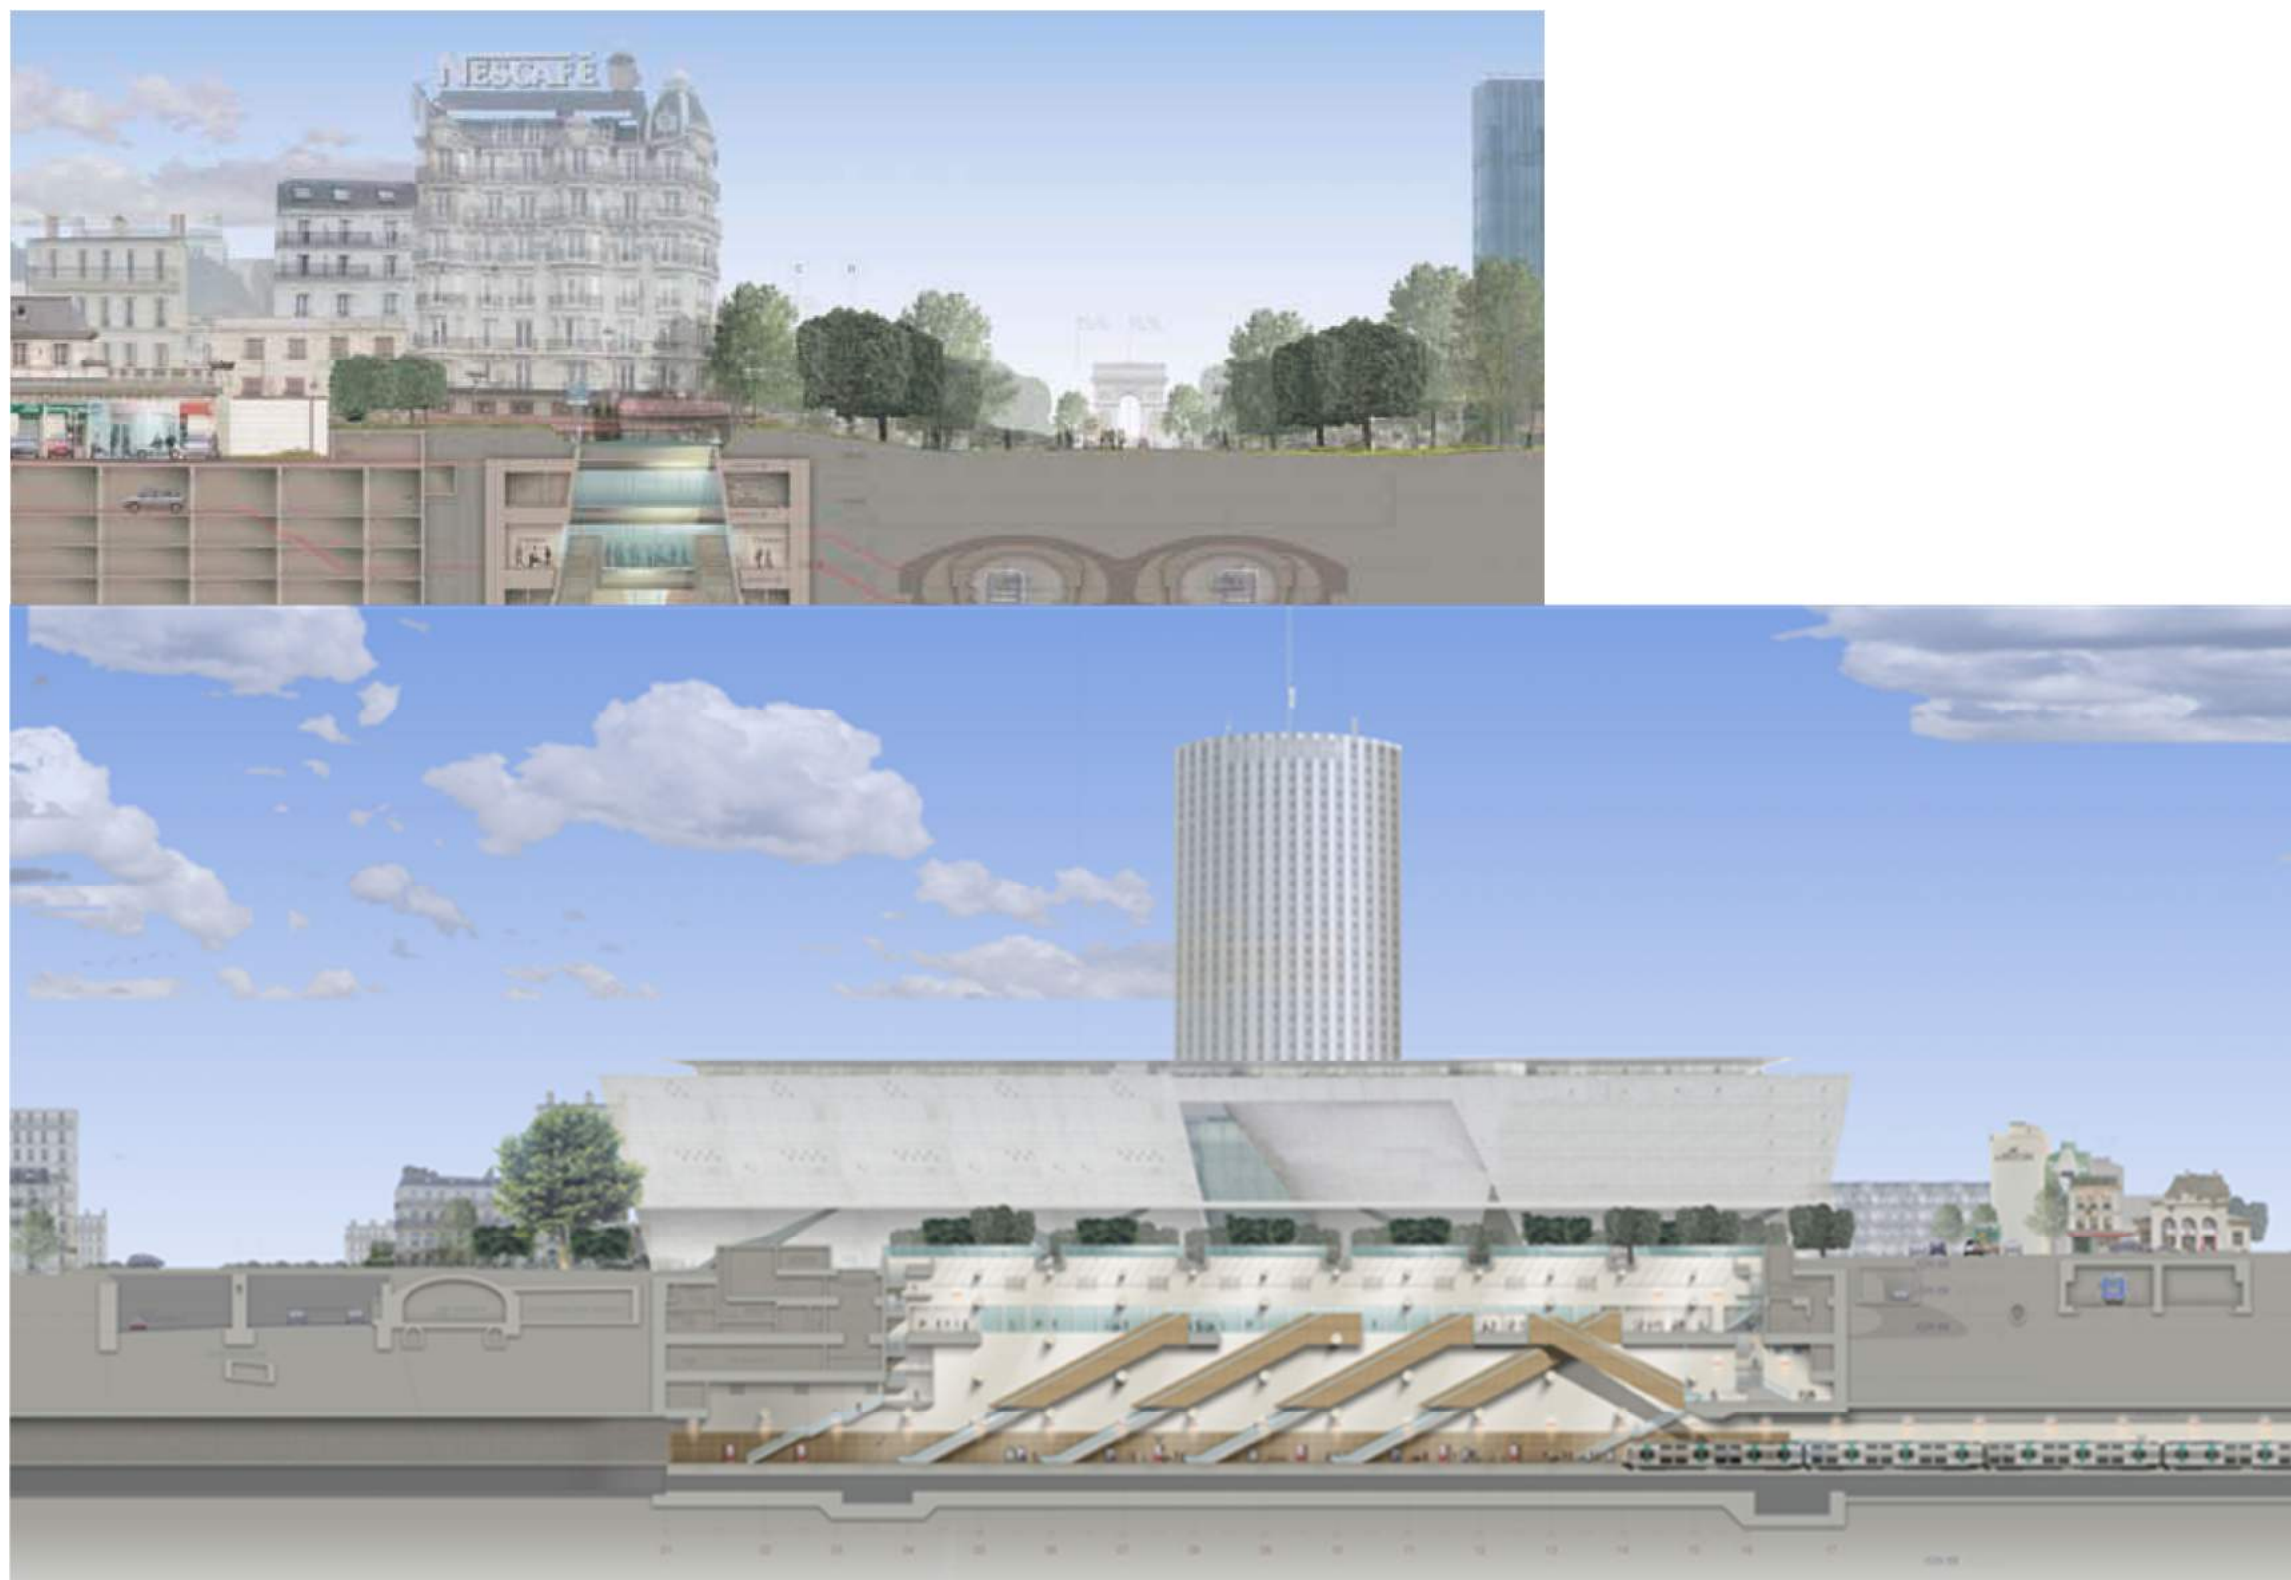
Vue en coupe et coupe longitudinale de la gare Porte Maillot
